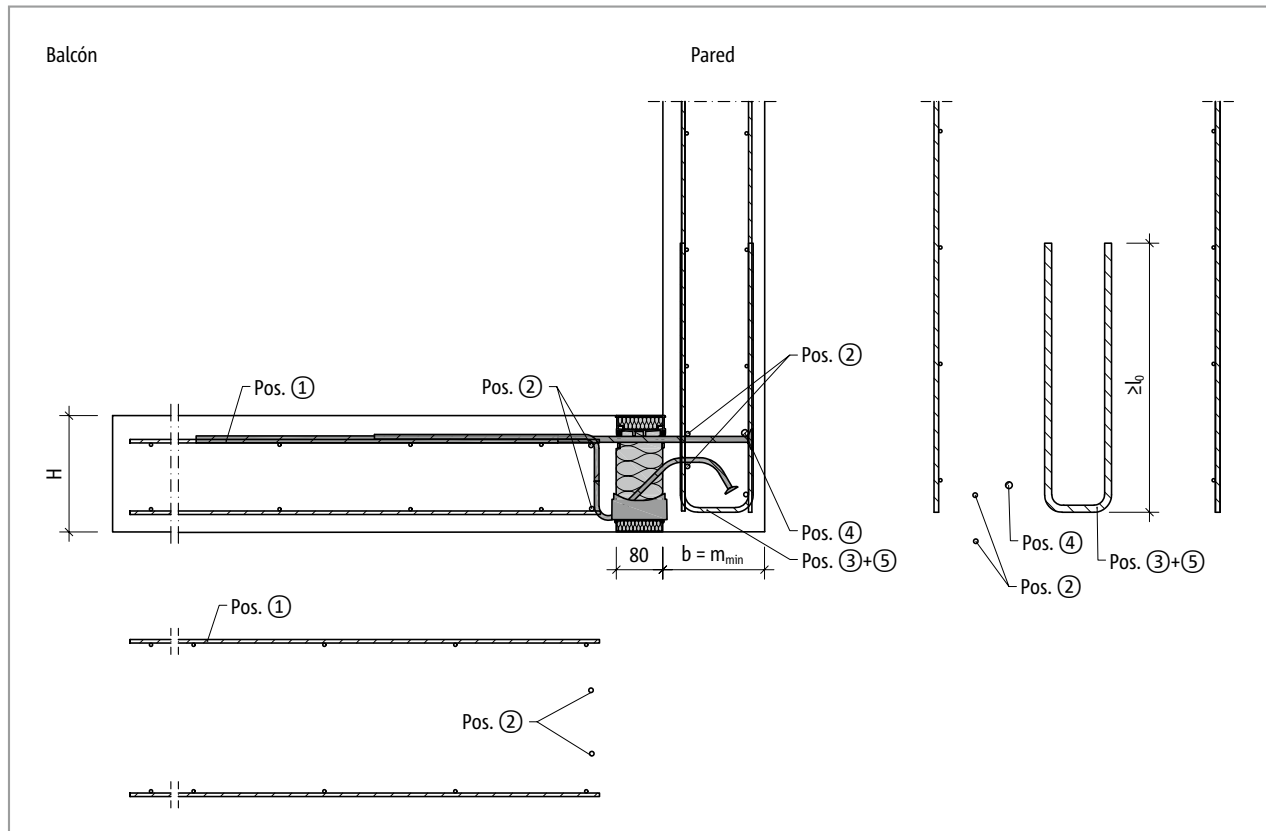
Schöck Isokorb® T tipo K-U: Armadura in situ para conexión a pared con dimensión mínima del elemento constructivo ($m_{exist} = m_{min}$)
